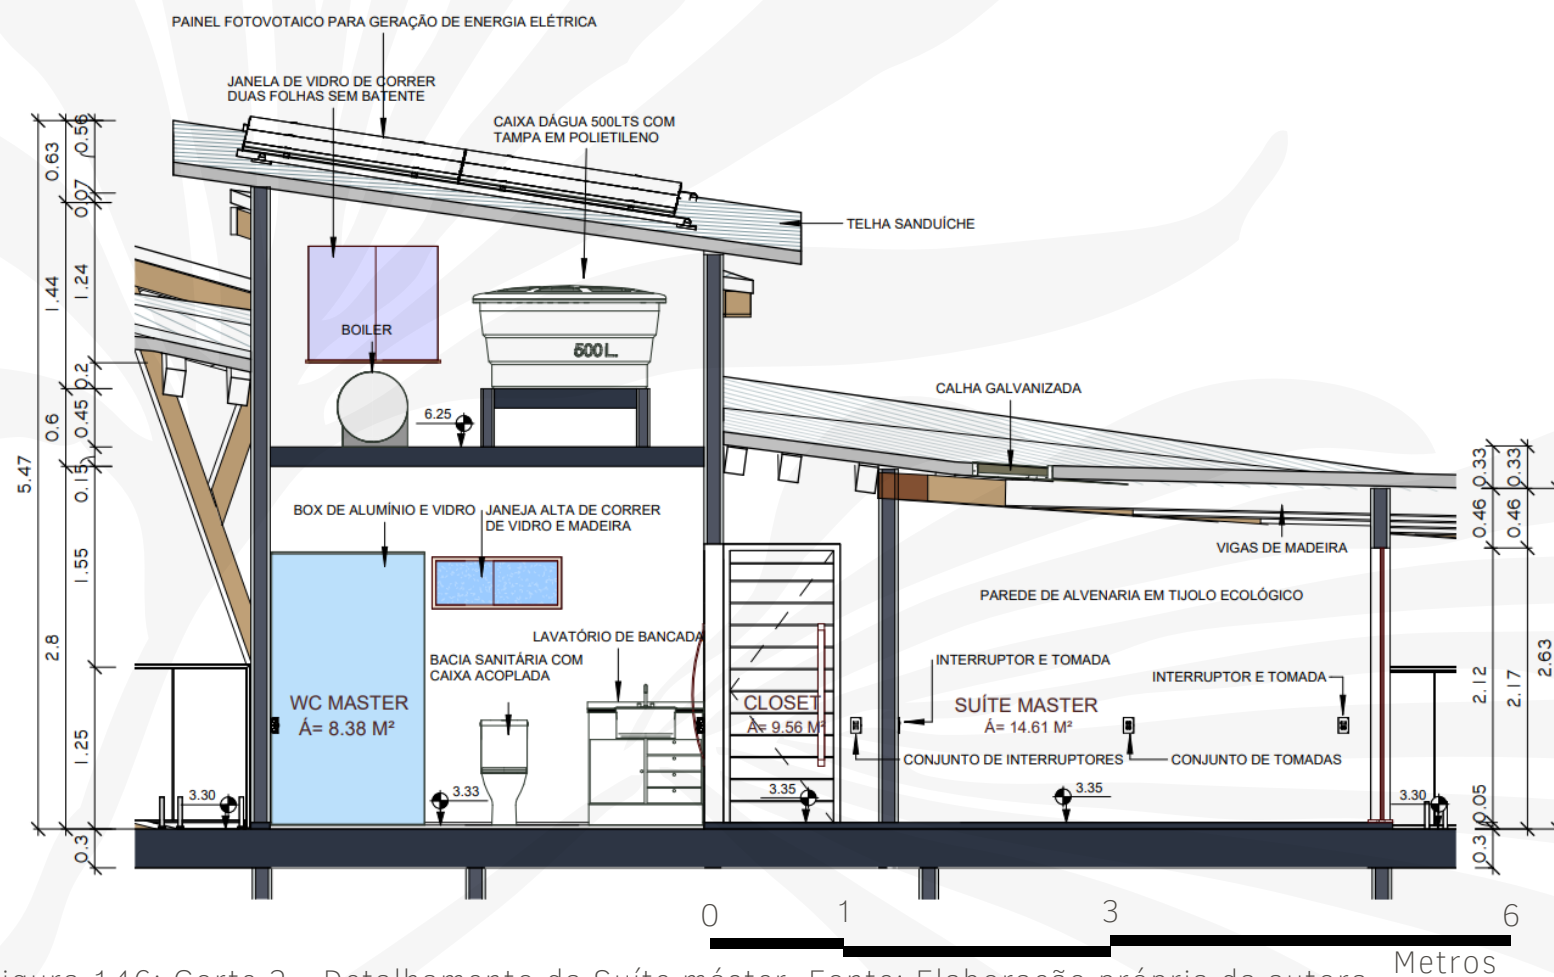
Corte 2 - Detalhamento da Suíte máster. Fonte: Elaboração própria da autora.
